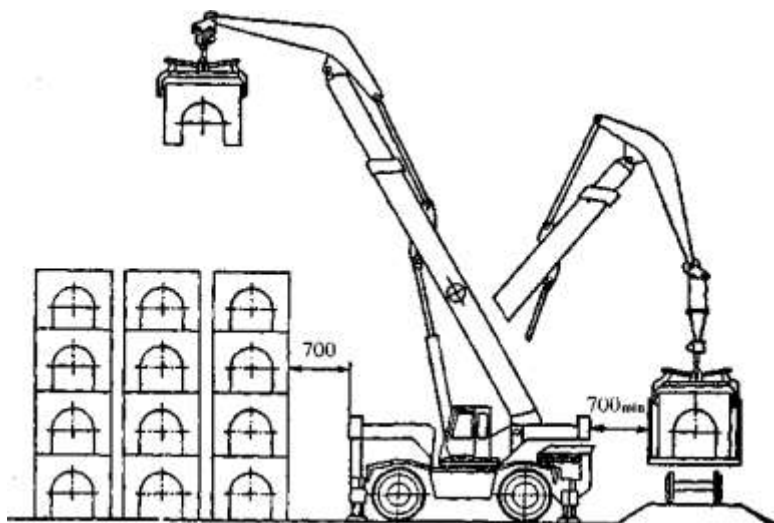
Кран-манипулятор для перегрузки утяжелителей для трубопроводов.
